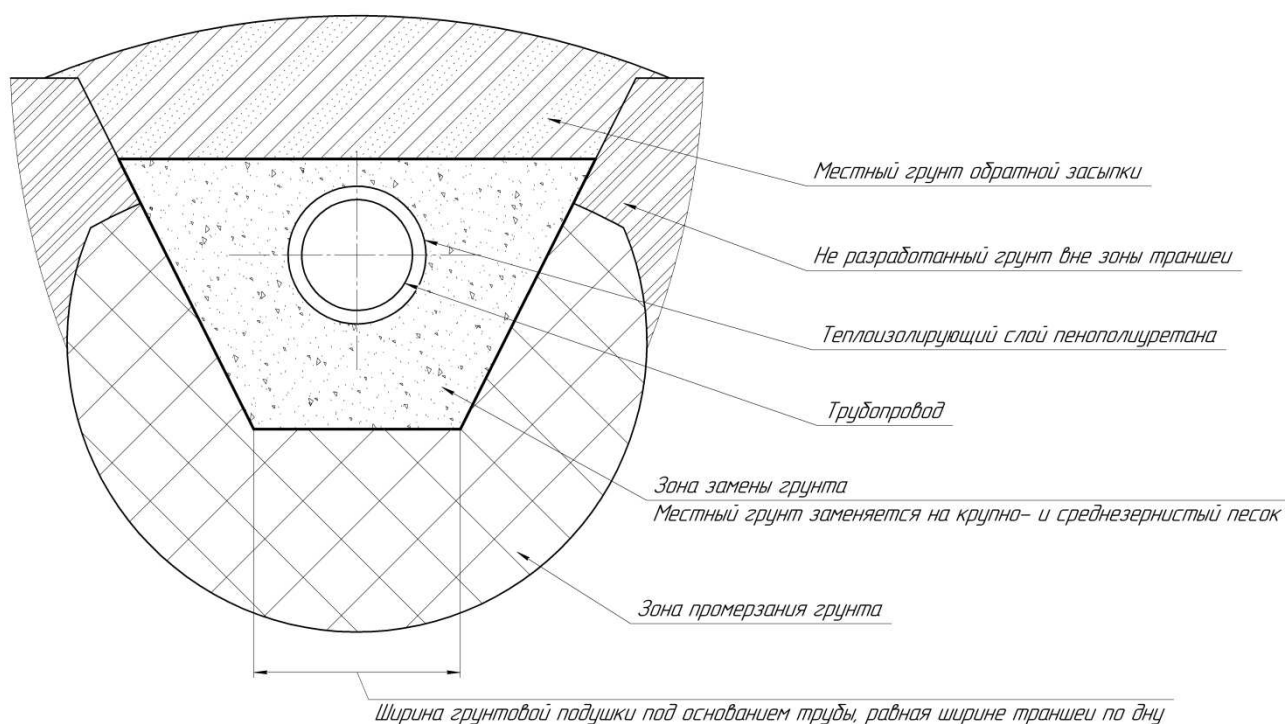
Схема подземной прокладки трубопровода с применением теплоизоляции трубопровода и обустройством грунтовой конструкции
